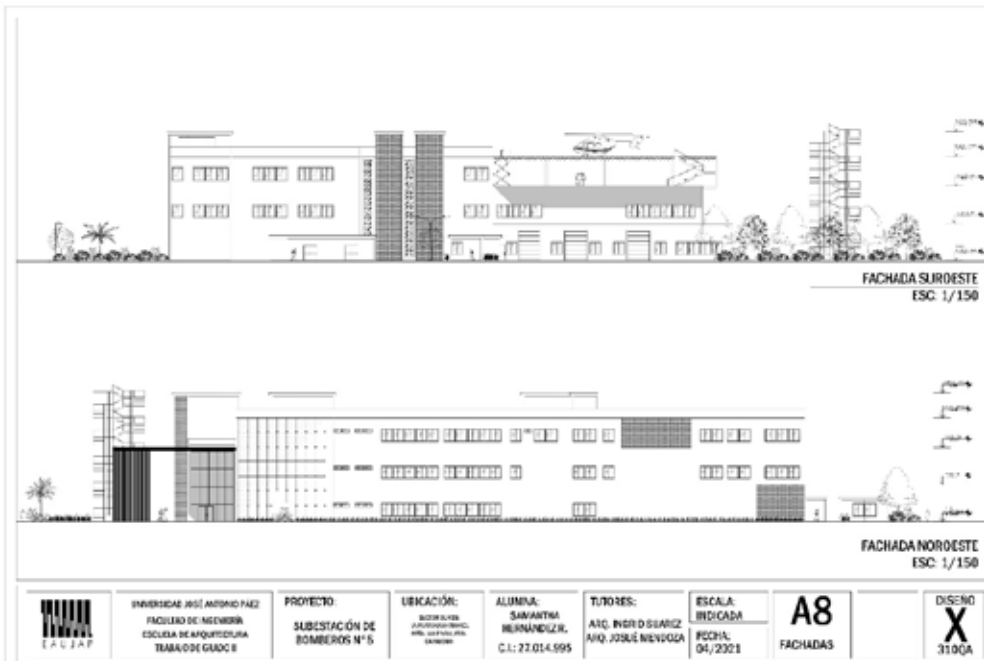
Fachadas A8. Fuente: La Autora (2021)
